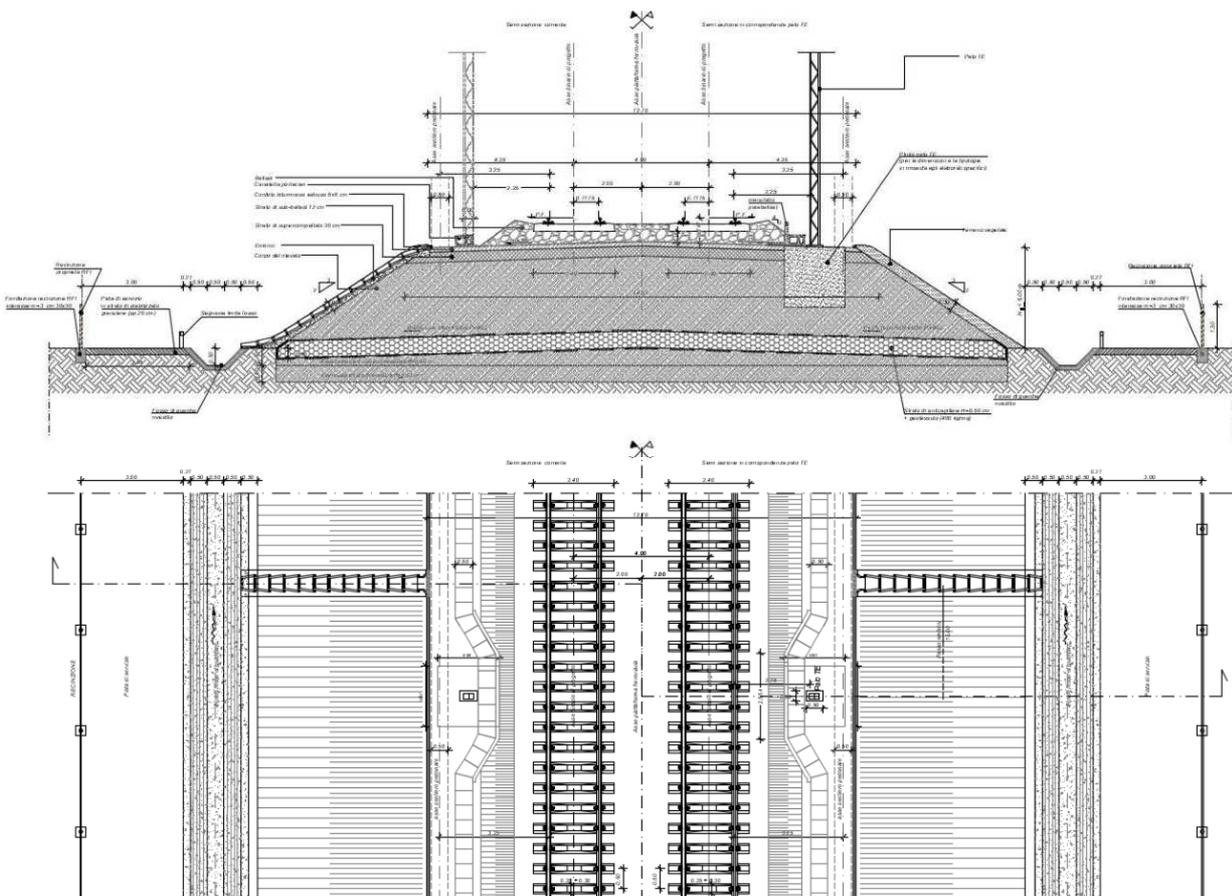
Sezione ferroviaria in rilevato a doppia linea
